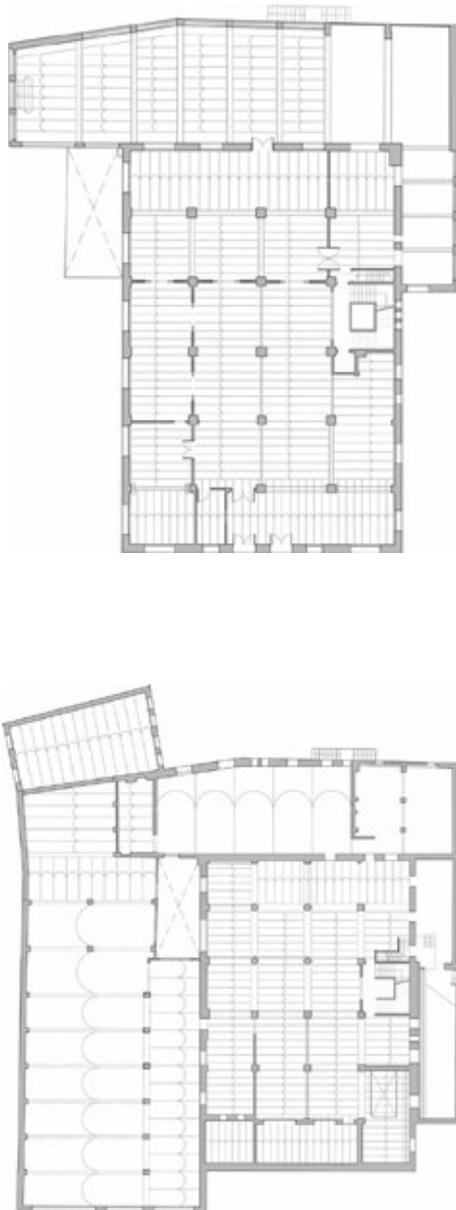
Plantas del Hotel Rosaleda. Correlativamente la planta sótano, con las bóvedas de mayor luz, y la planta baja, con la sala del servicio donde las bóvedas quedaban ocultas por el falso techo.
